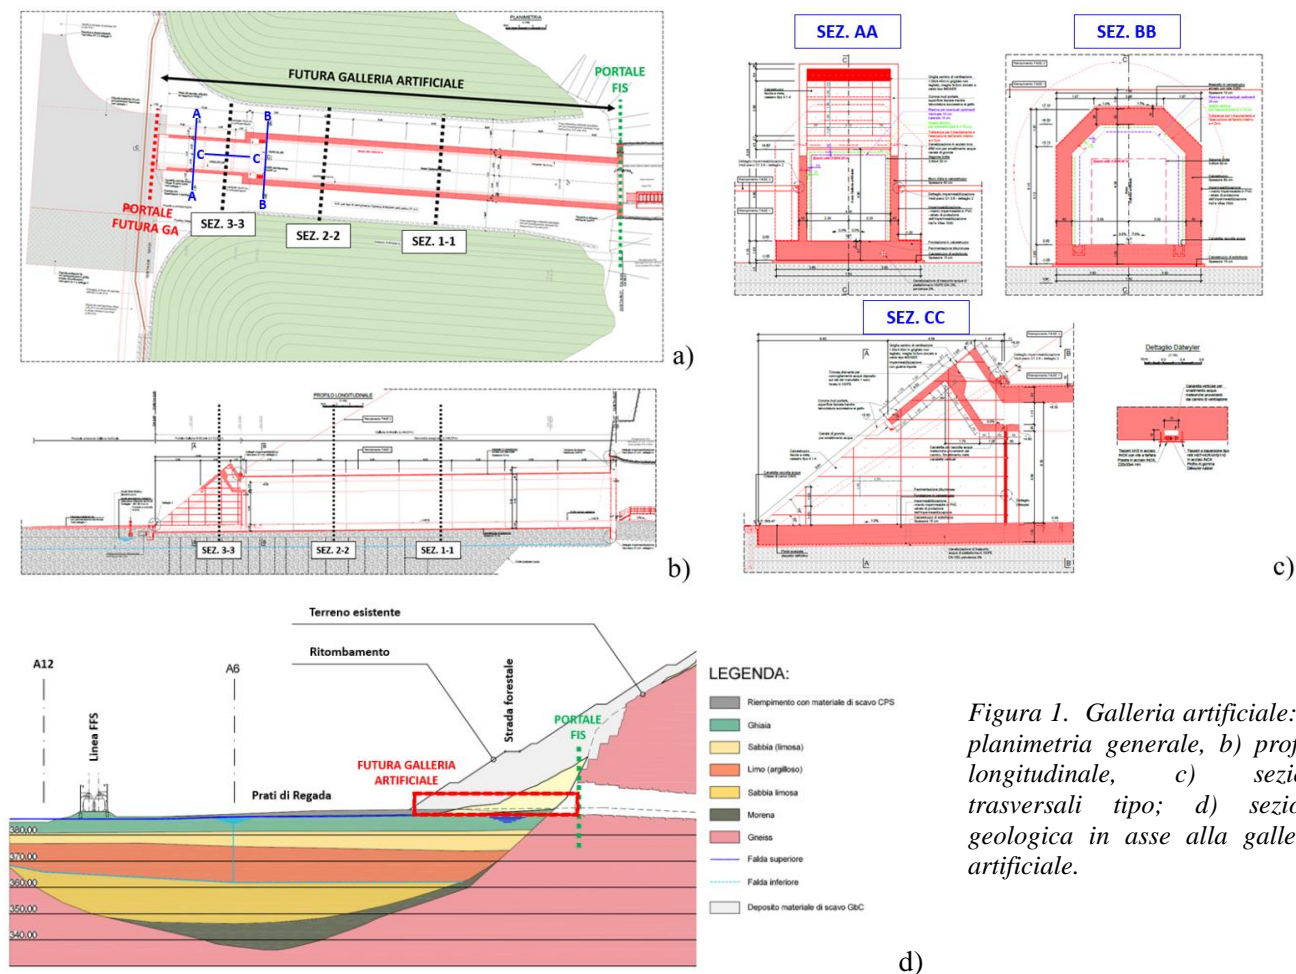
Galleria artificiale: a) planimetria generale, b) profilo longitudinale, c) sezioni trasversali tipo; d) sezione geologica in asse alla galleria artificiale.
